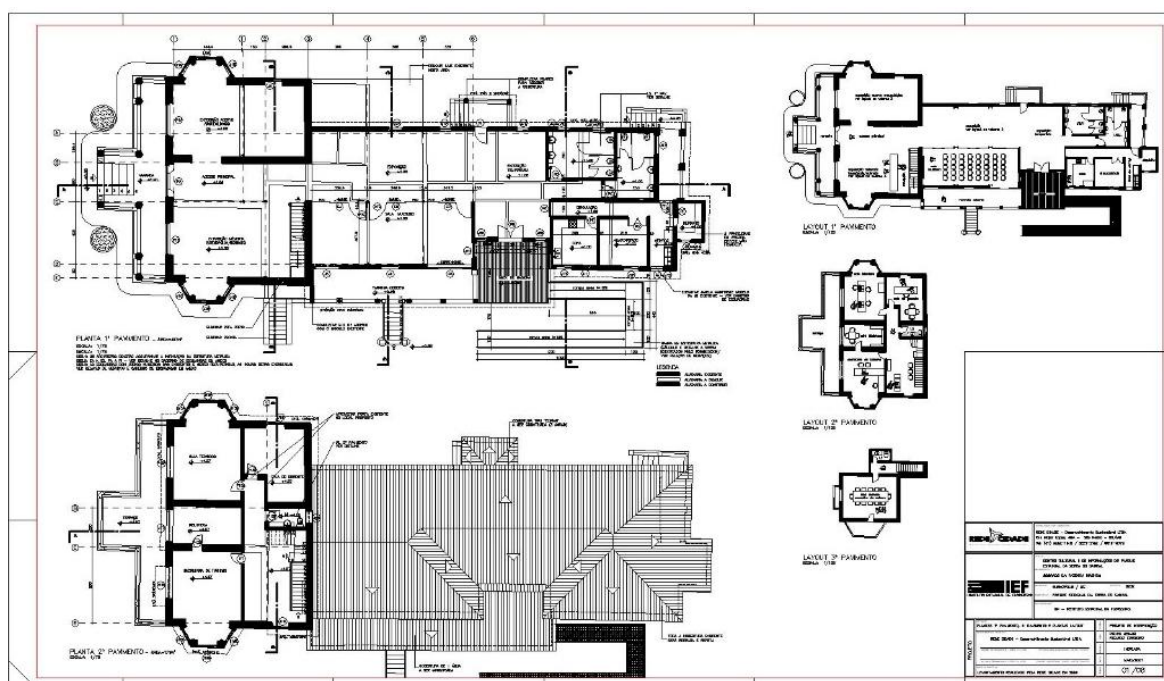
Reprodução Projeto Intervenção. Plantas 1 e 2º pavto. Fonte: IEF, 2007.
